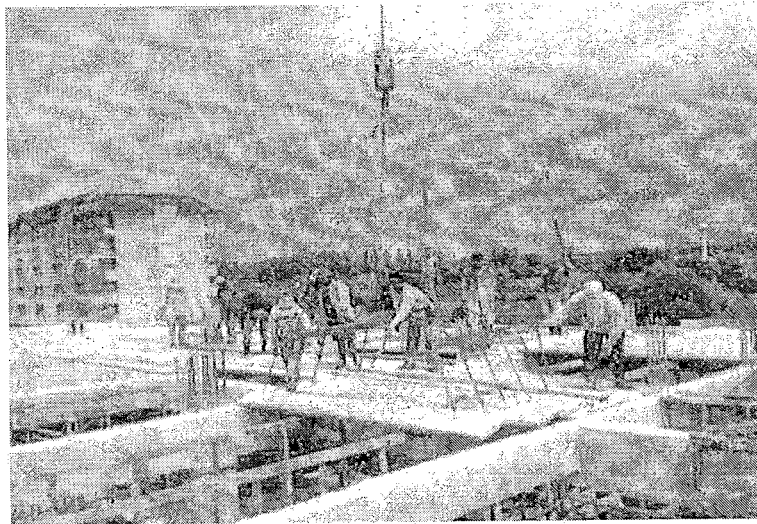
รายละเอียดของการเสริมเหล็กทั่วไป ที่ก่อสร้างในประเทศไทย [7]
